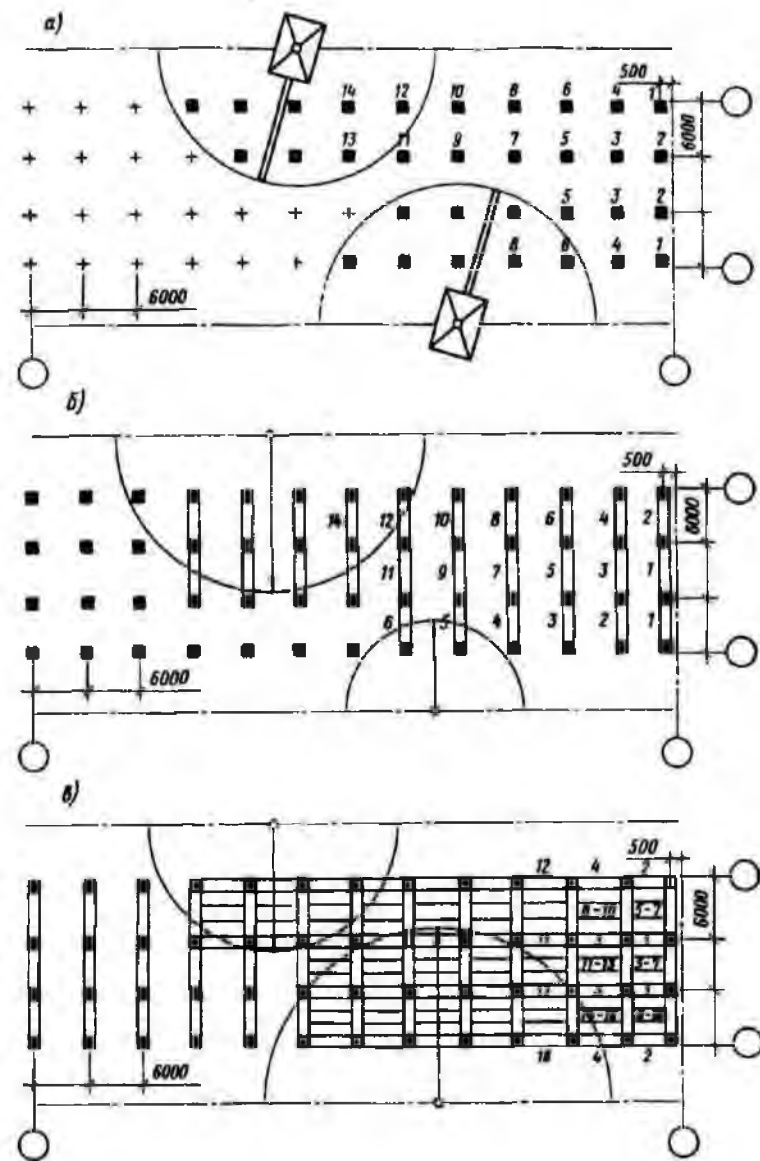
Схема монтажа бескрановых промышленных зданий двумя башенными кранами:
